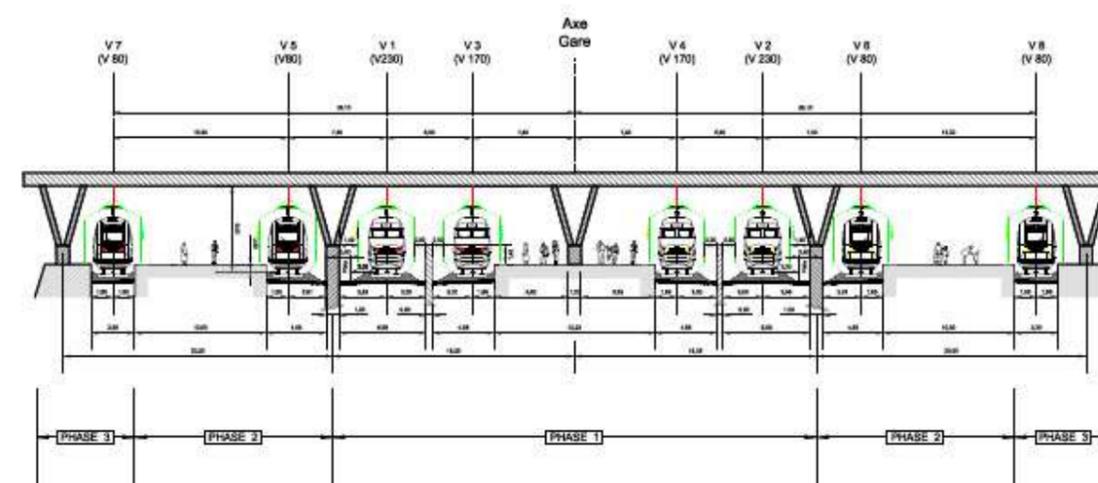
Coupe transversale du plan de voies et phasage de réalisation
